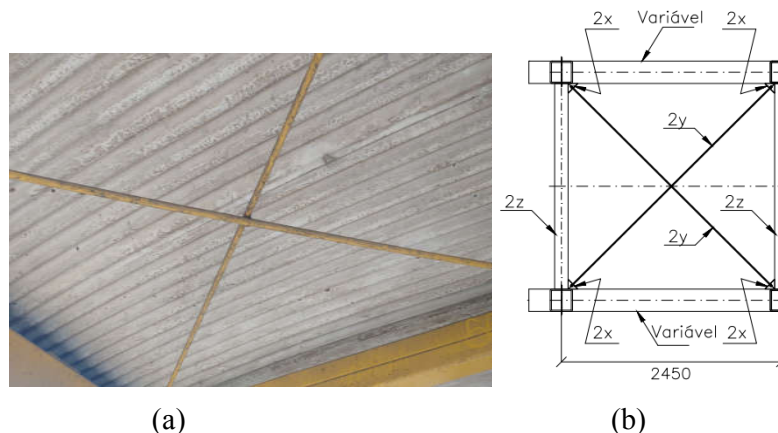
(a) Foto da telha e dos enrijecedores laterais e (b) Vista superior do projeto dos enrijecedores do teto (dimensões em mm)
